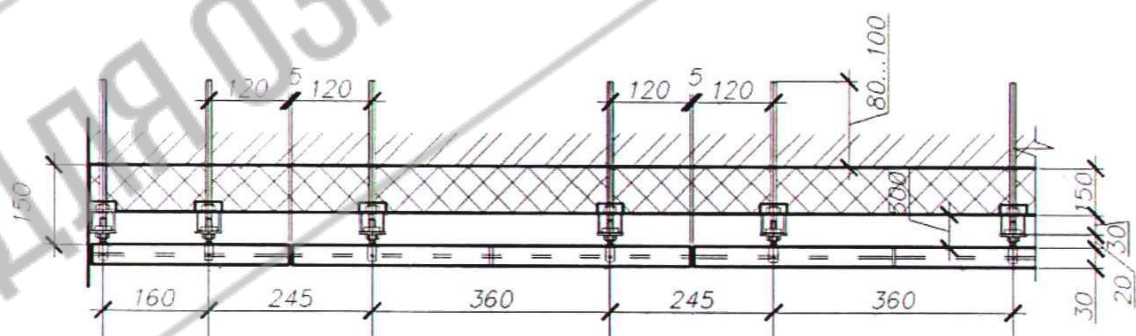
Разрез фрагмента облицовки стены Б-Б
